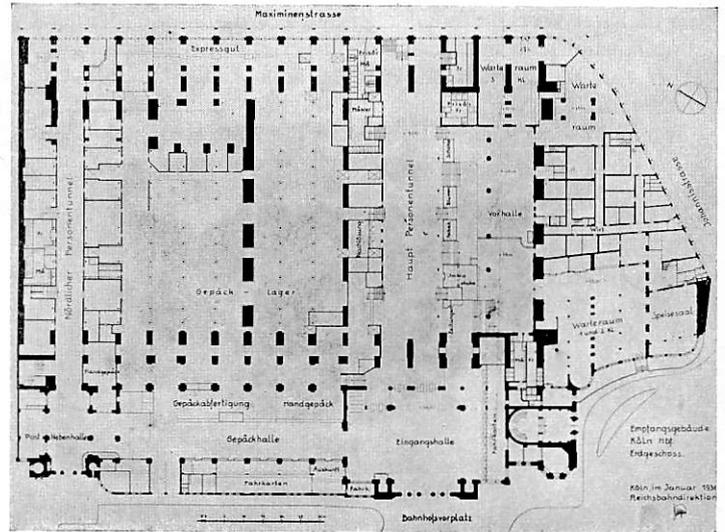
Grundriß des Kölner Hauptbahnhofs (Erdgeschoß) Bauzustand 1937.
